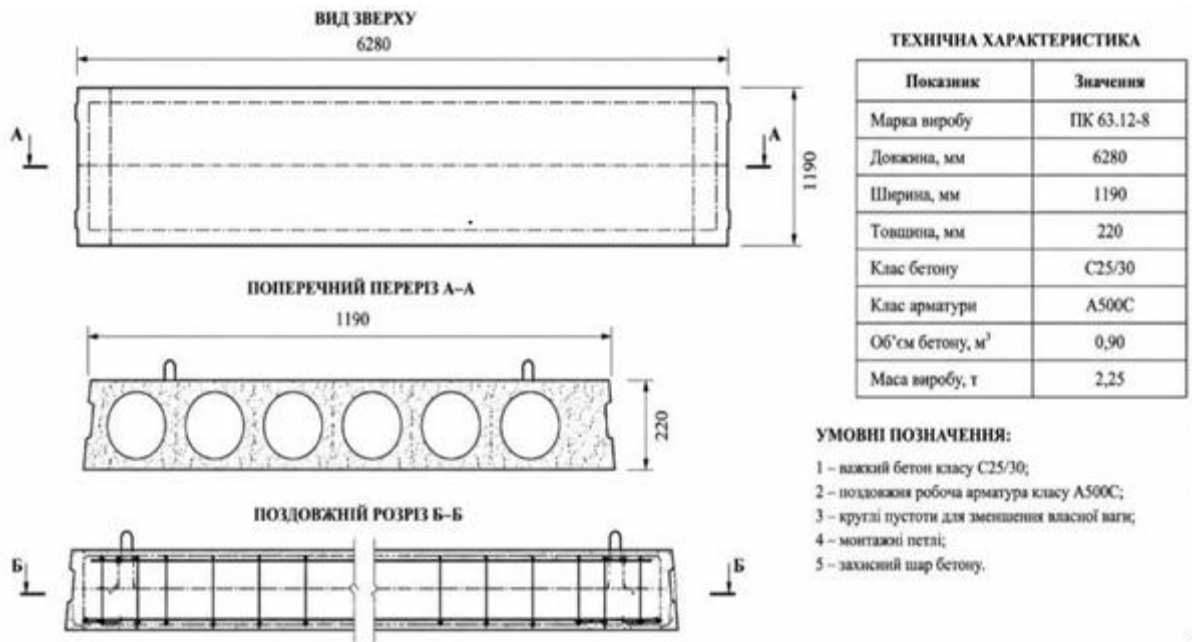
Багатопустотна плита перекриття ПК 63.12-8 [5]
